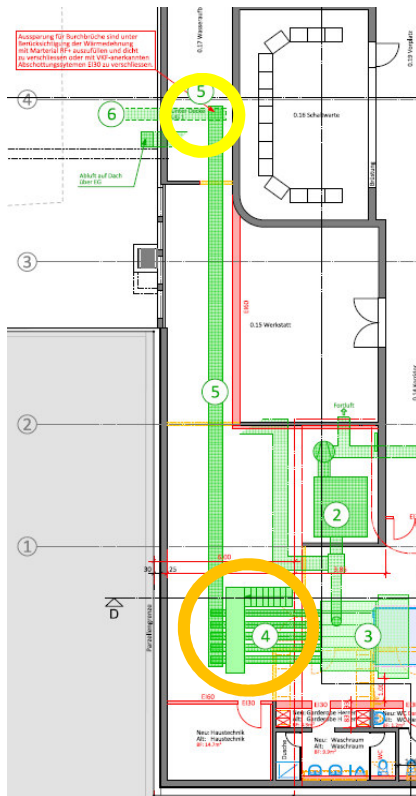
Ausschnitt Grundriss EG, Übergabestellen Pelletförderung
